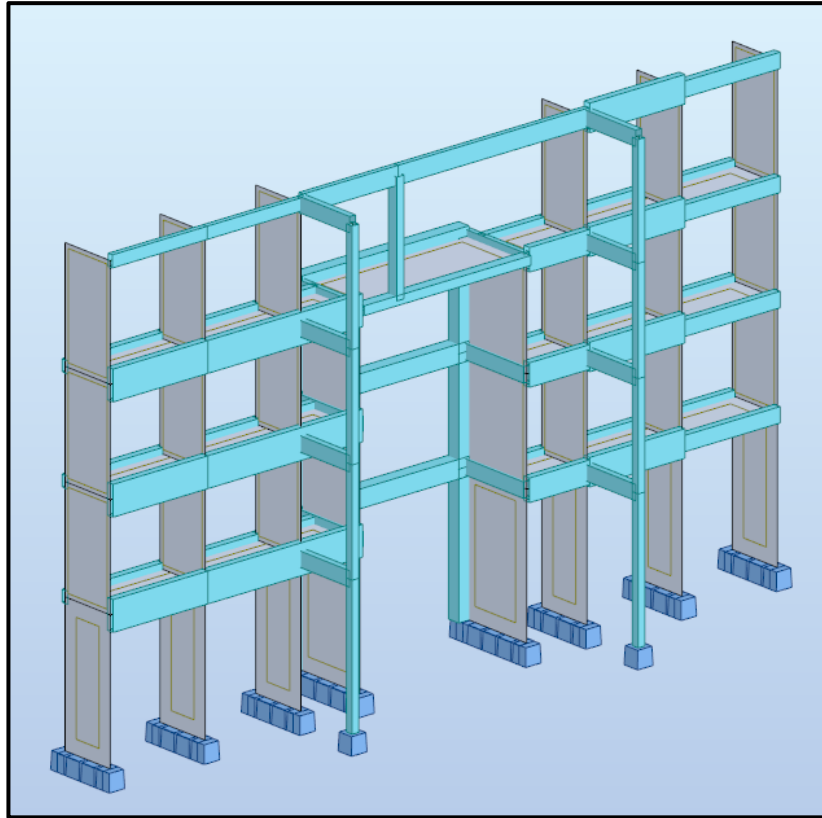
vue de face de la nouvelle façade du siège ADDOHA renforcée en béton armé
